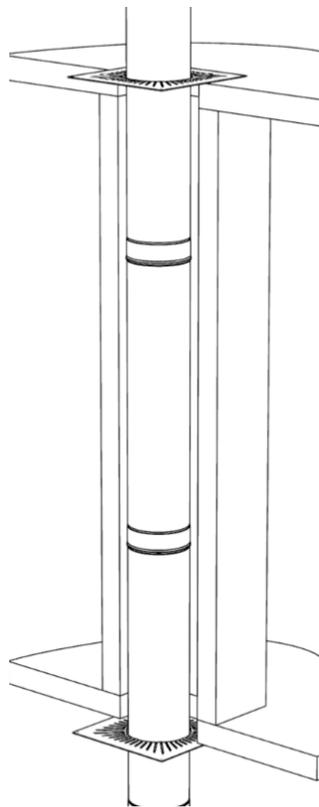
piastre ventilate in passaggio d'aria di legno.
